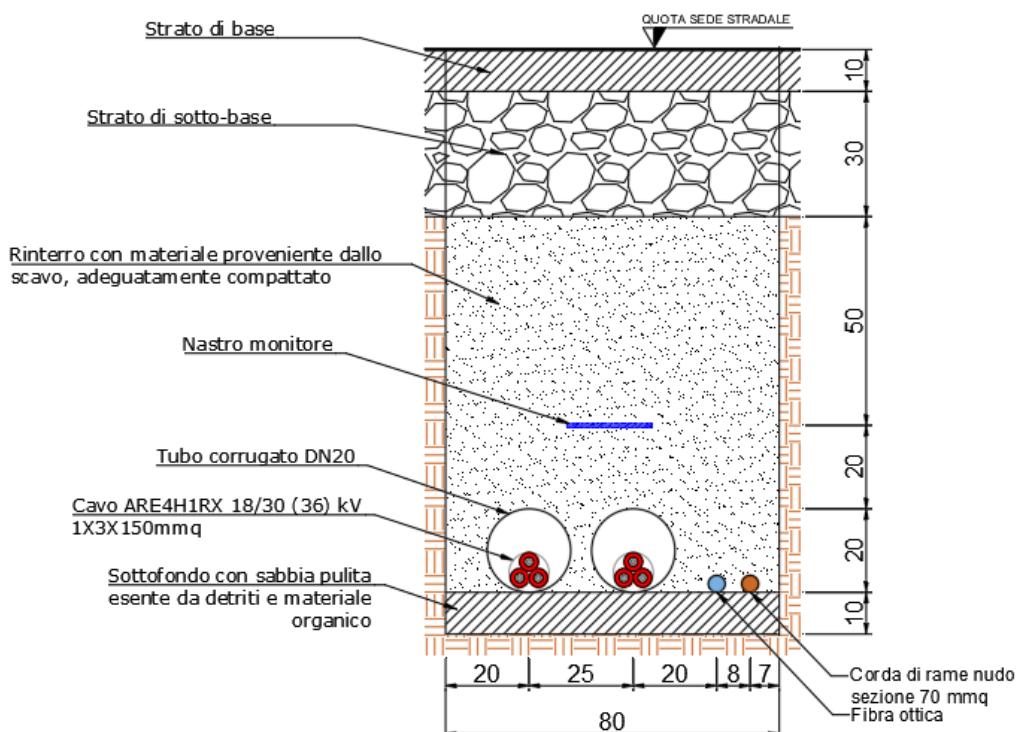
Tipico di sezione cavidotto MT- BESS su strada bianca
